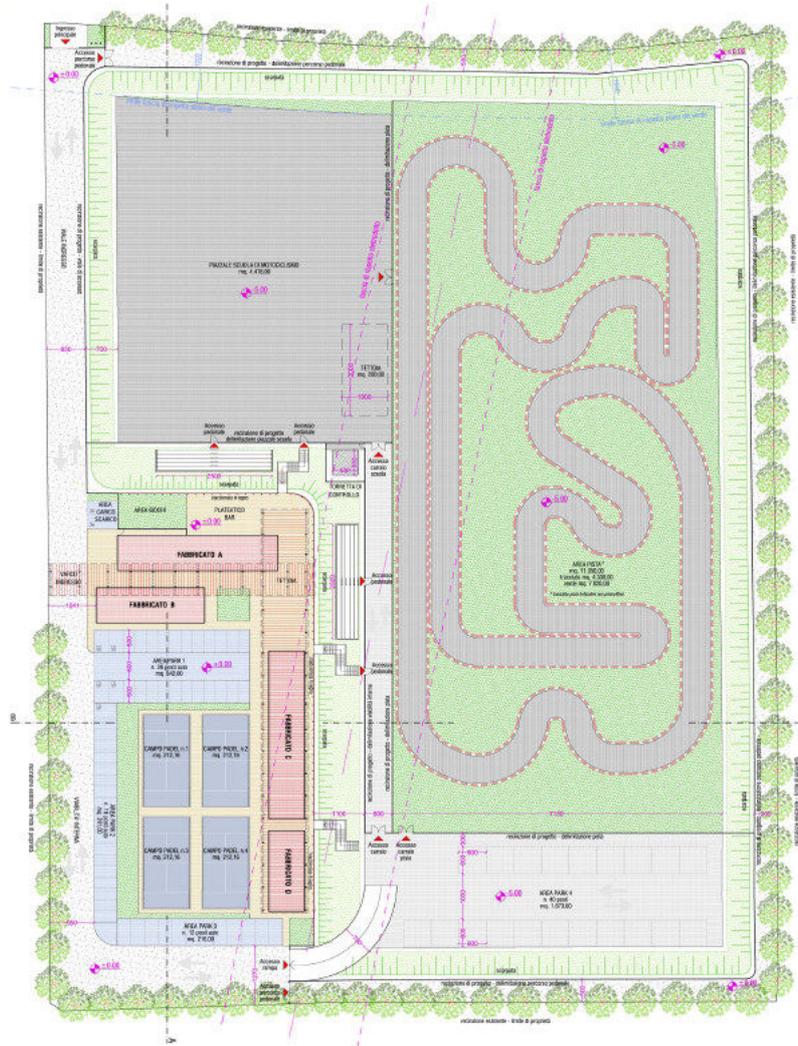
planimetria generale dell'intervento (tracciato delle pista indicativo)
